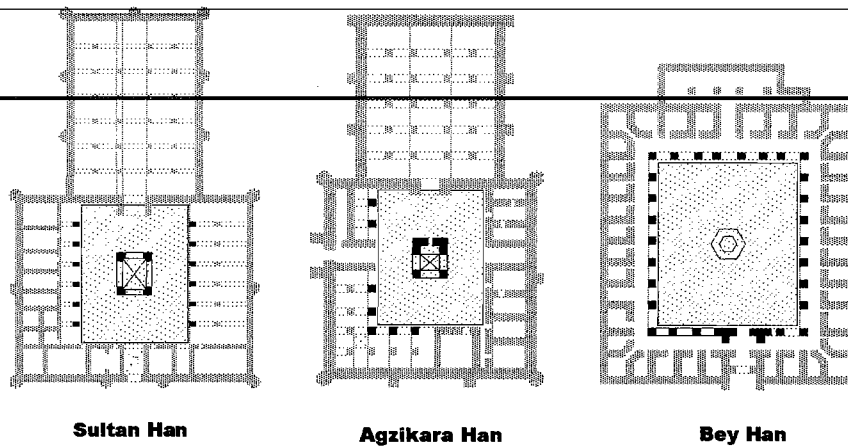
Denah Simetris Bilateral-Anatolia
